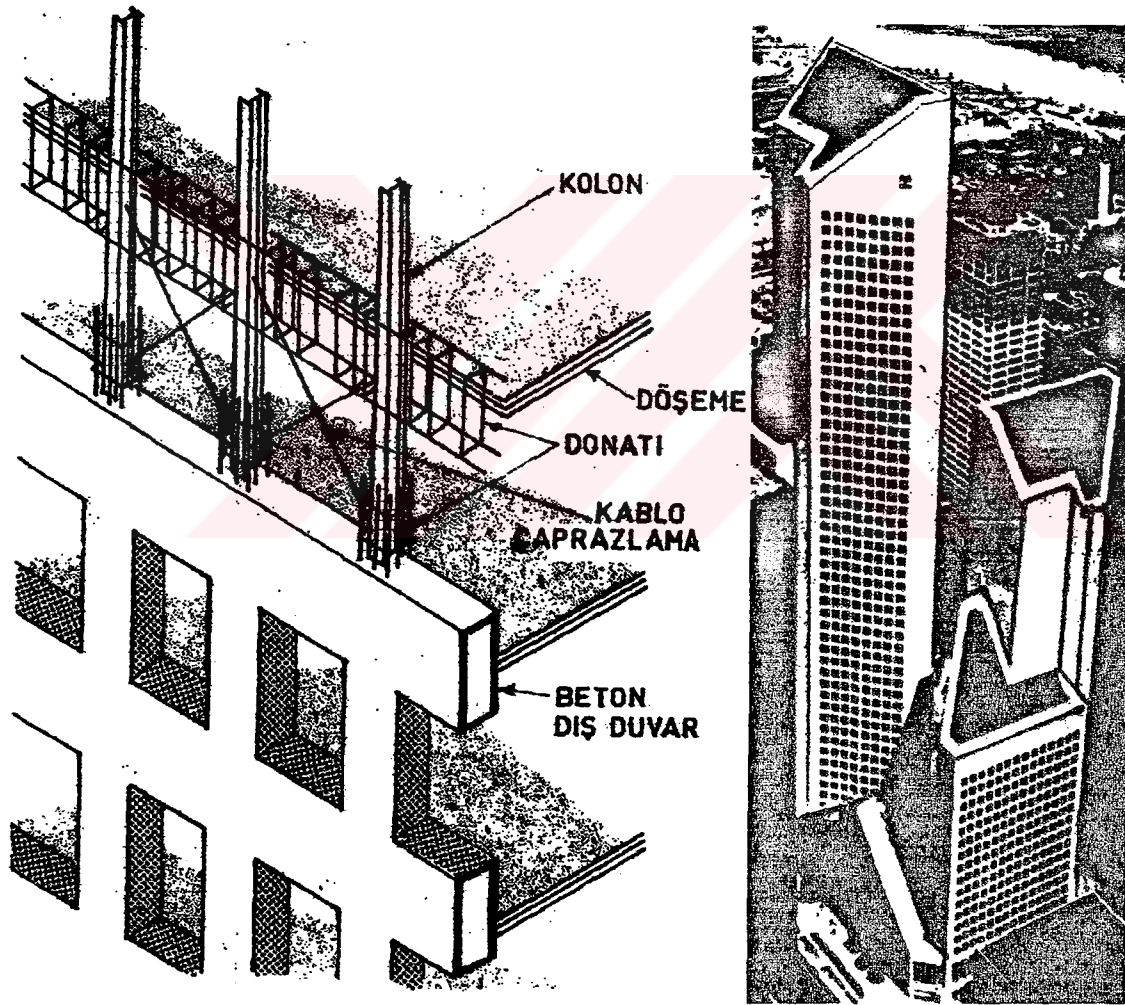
Betonarme podyumlu ve çekirdekli kompozit yapı. Nat West Tower Londra.[4]
